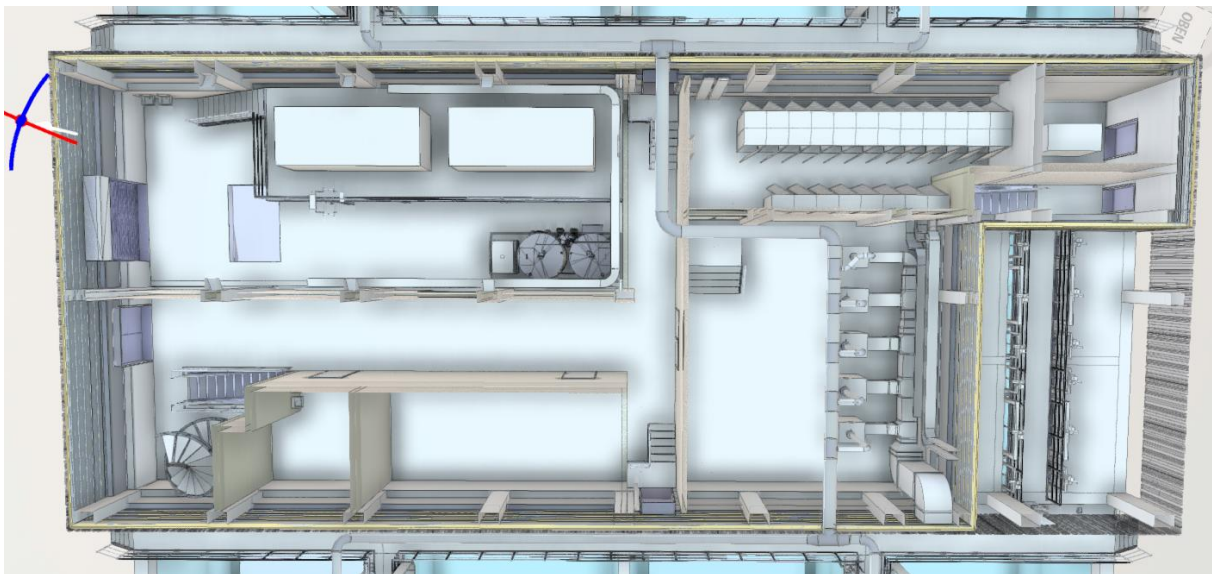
Grundriss EG Maschinenhaus Belegung
